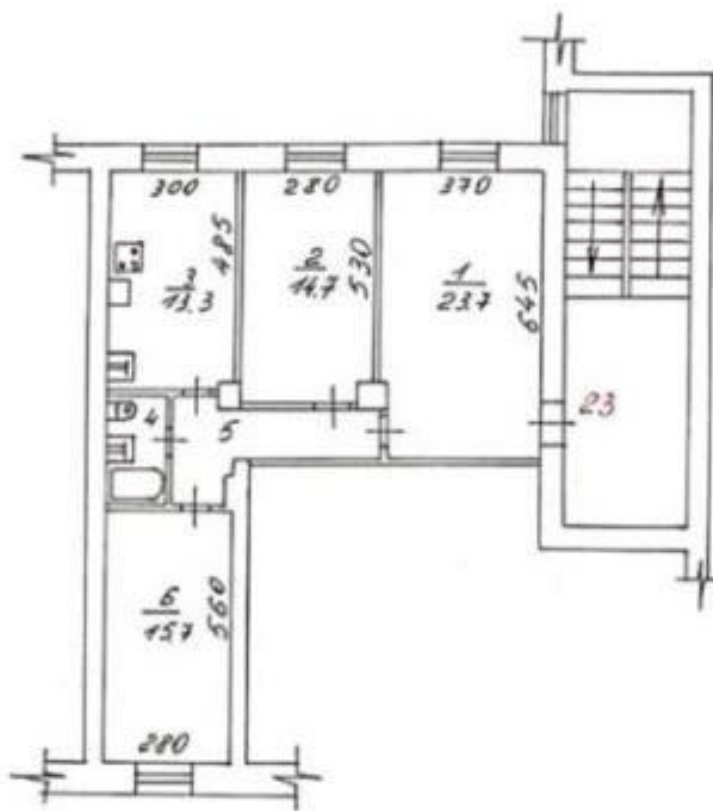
План квартиры до проведения перепланировки и переустройства.
